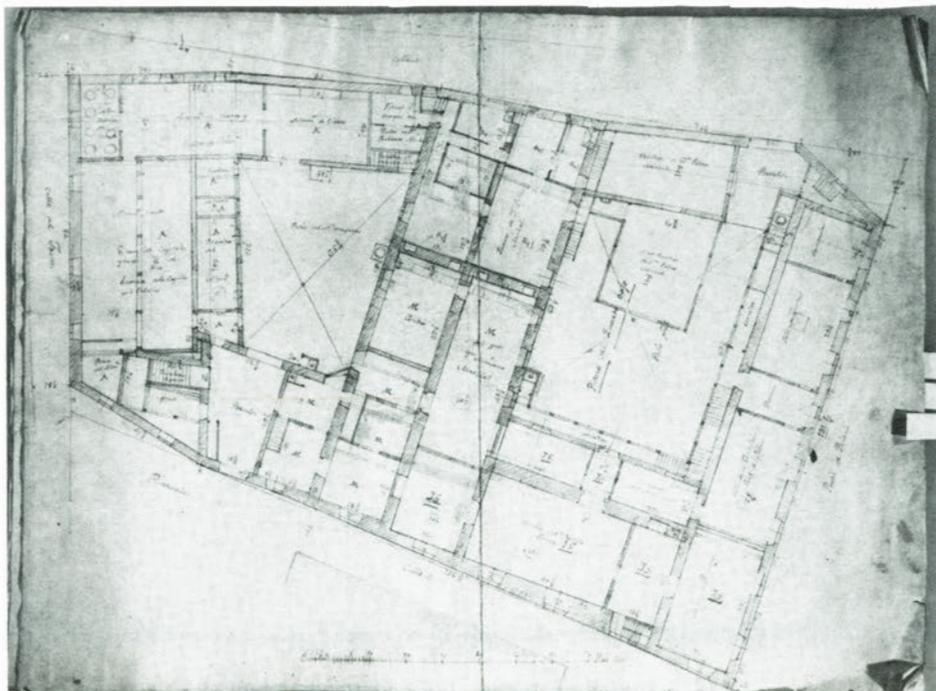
Casa de Rebeque, 1750. Planta baja (A.P.)
